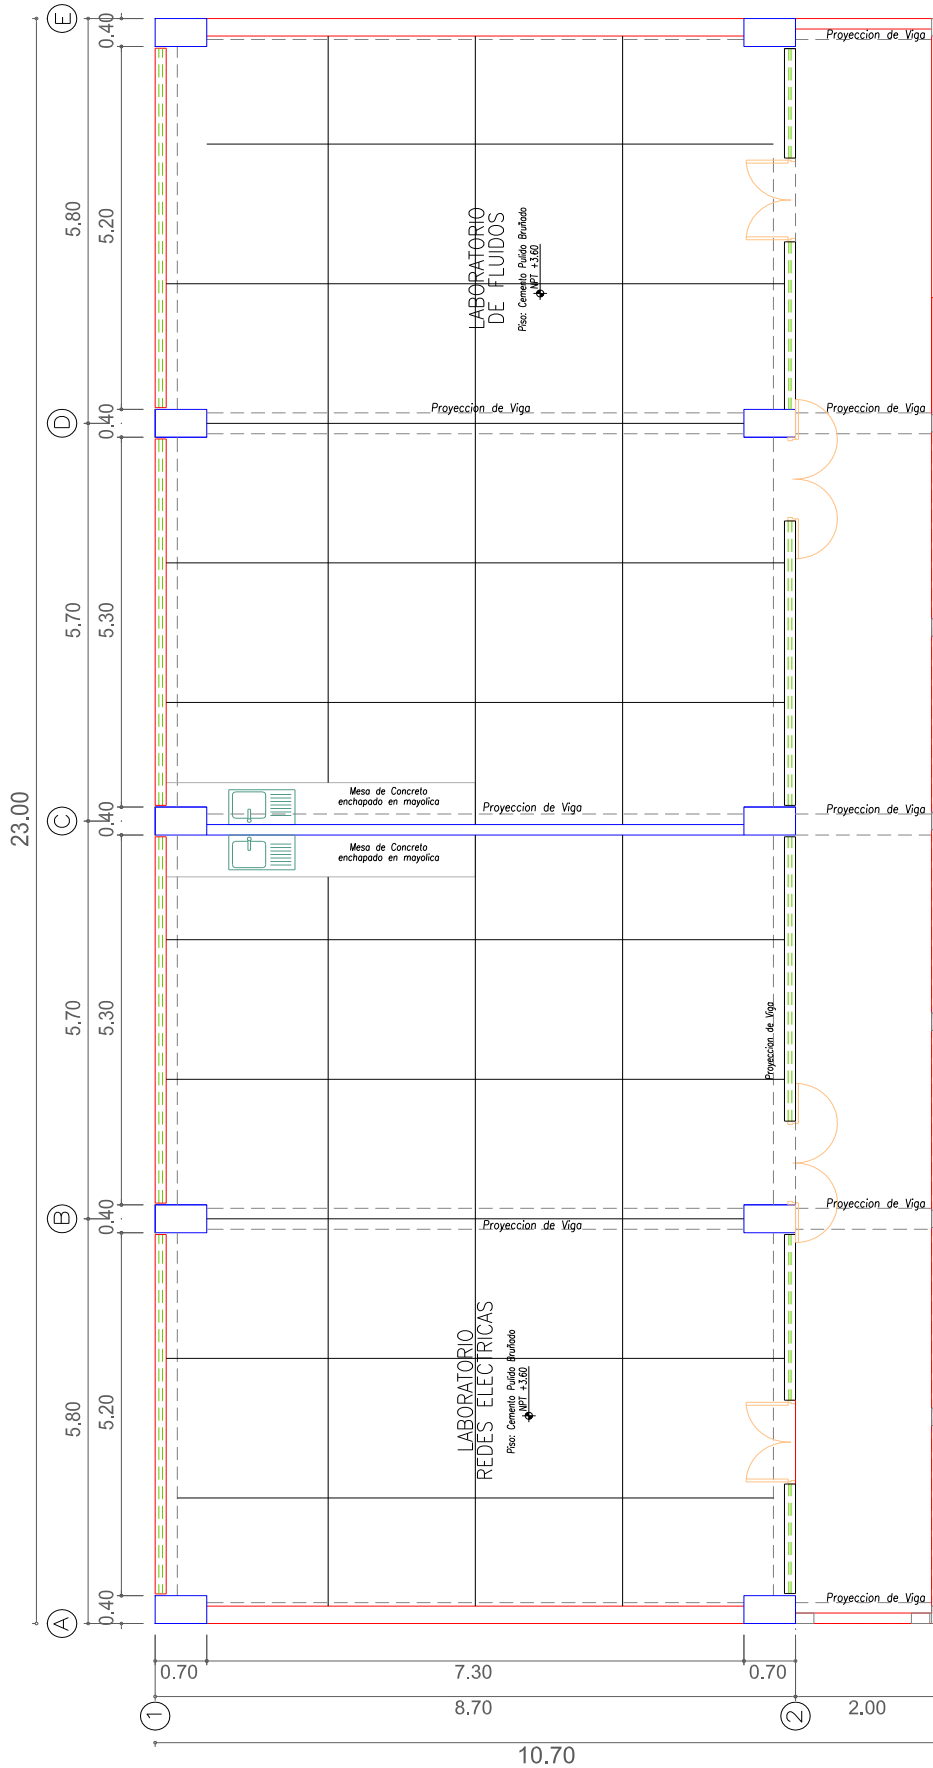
b. Planta arquitectónica segundo y tercer nivel edificio aislado.
